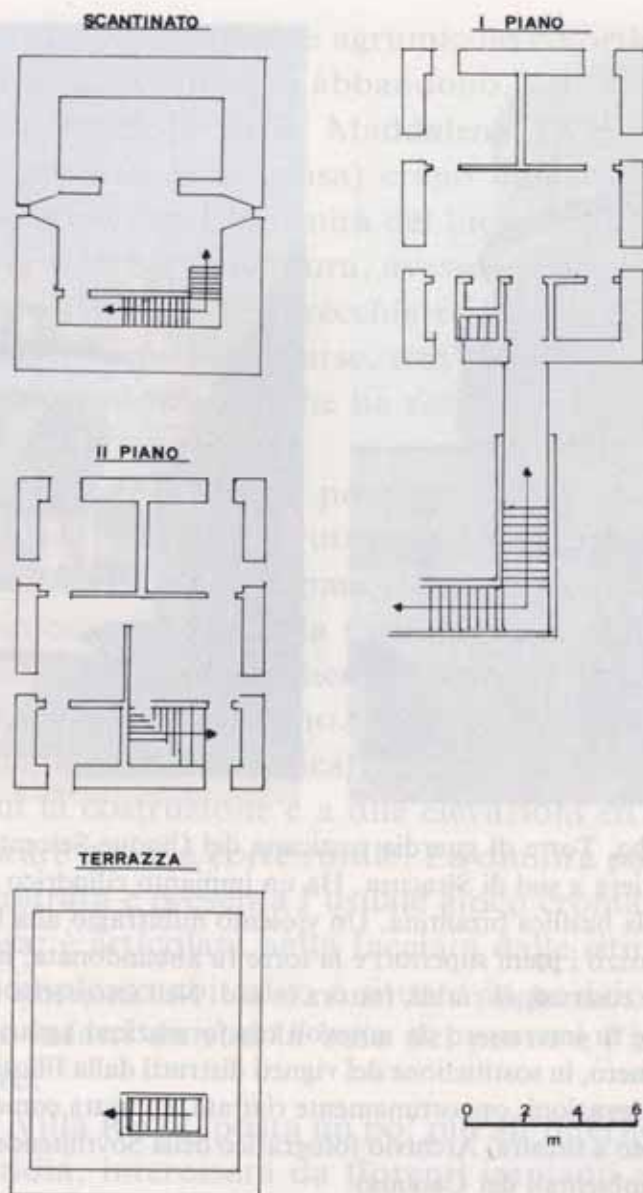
Rilievi planimetrici della Torre Milocca.
